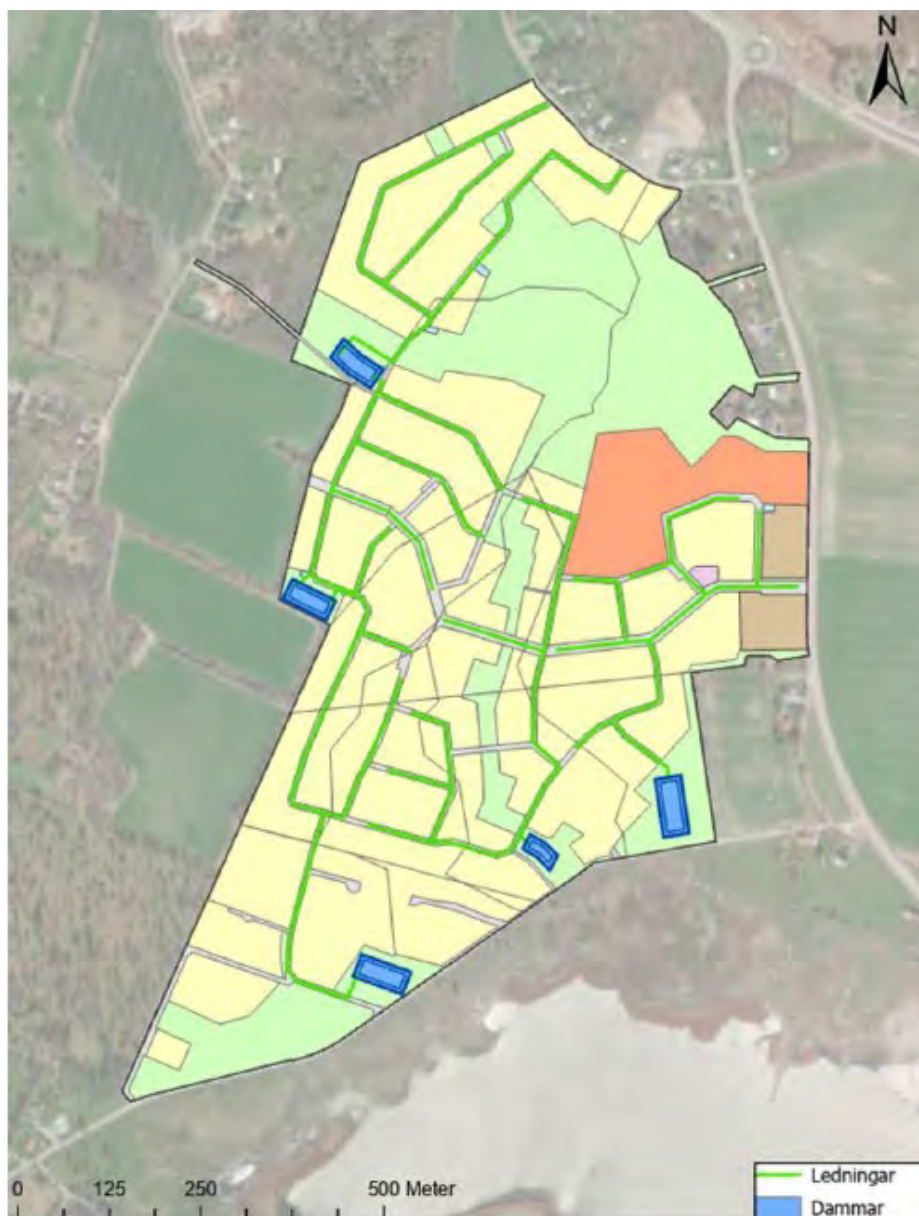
Principskiss över dagvattenhanteringen i planområdet.
